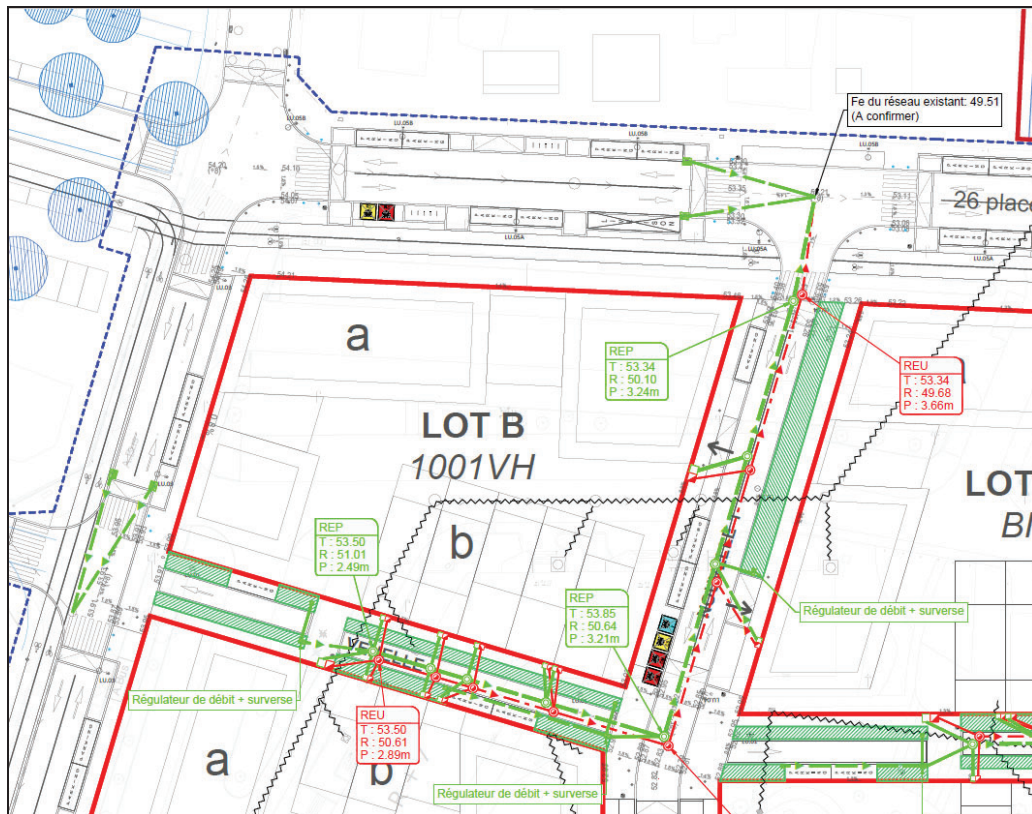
Canalisations d'eaux pluviales existantes et projet (LOT B)
